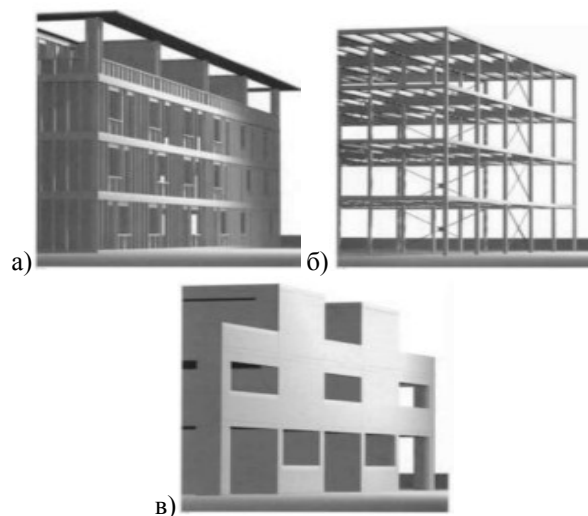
Конструктивные системы деревянных зданий [6]: а) каркасно-панельная; б) рамно-связевая; в) бескаркасная крупнопанельная / Structural systems of timber buildings: a) light weight frame; b) heavy frame; c) massive timber system
